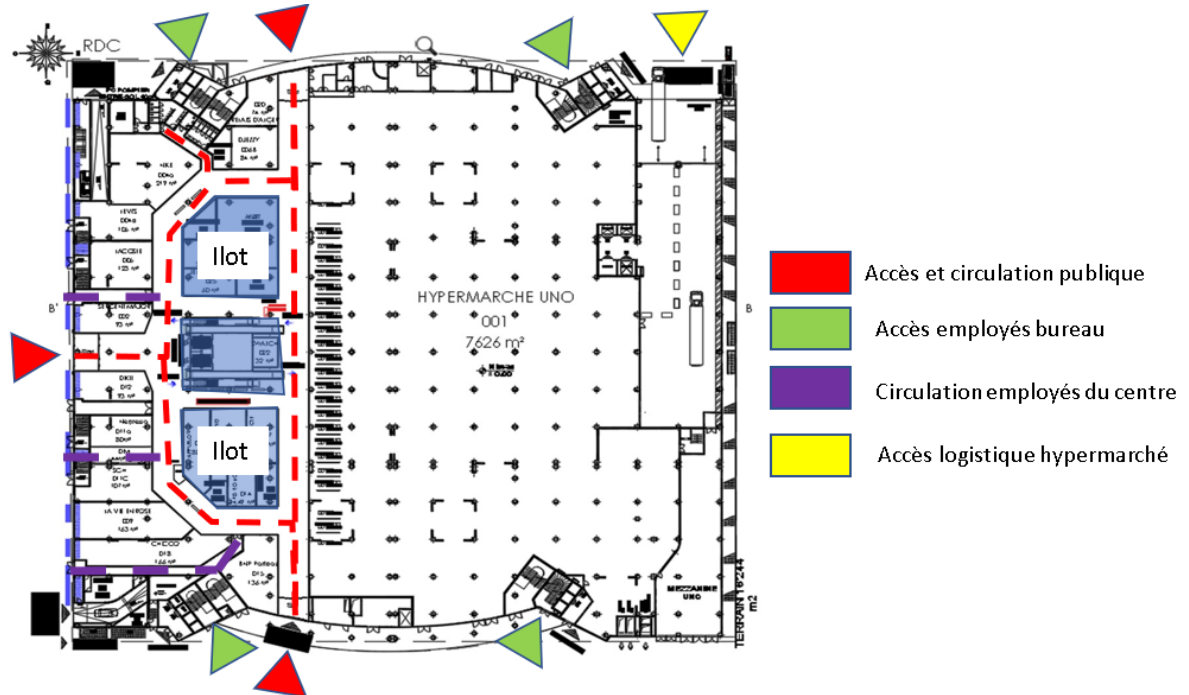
plan du RDC du centre commercial Bab Ezzouar. (Source : auteur).
